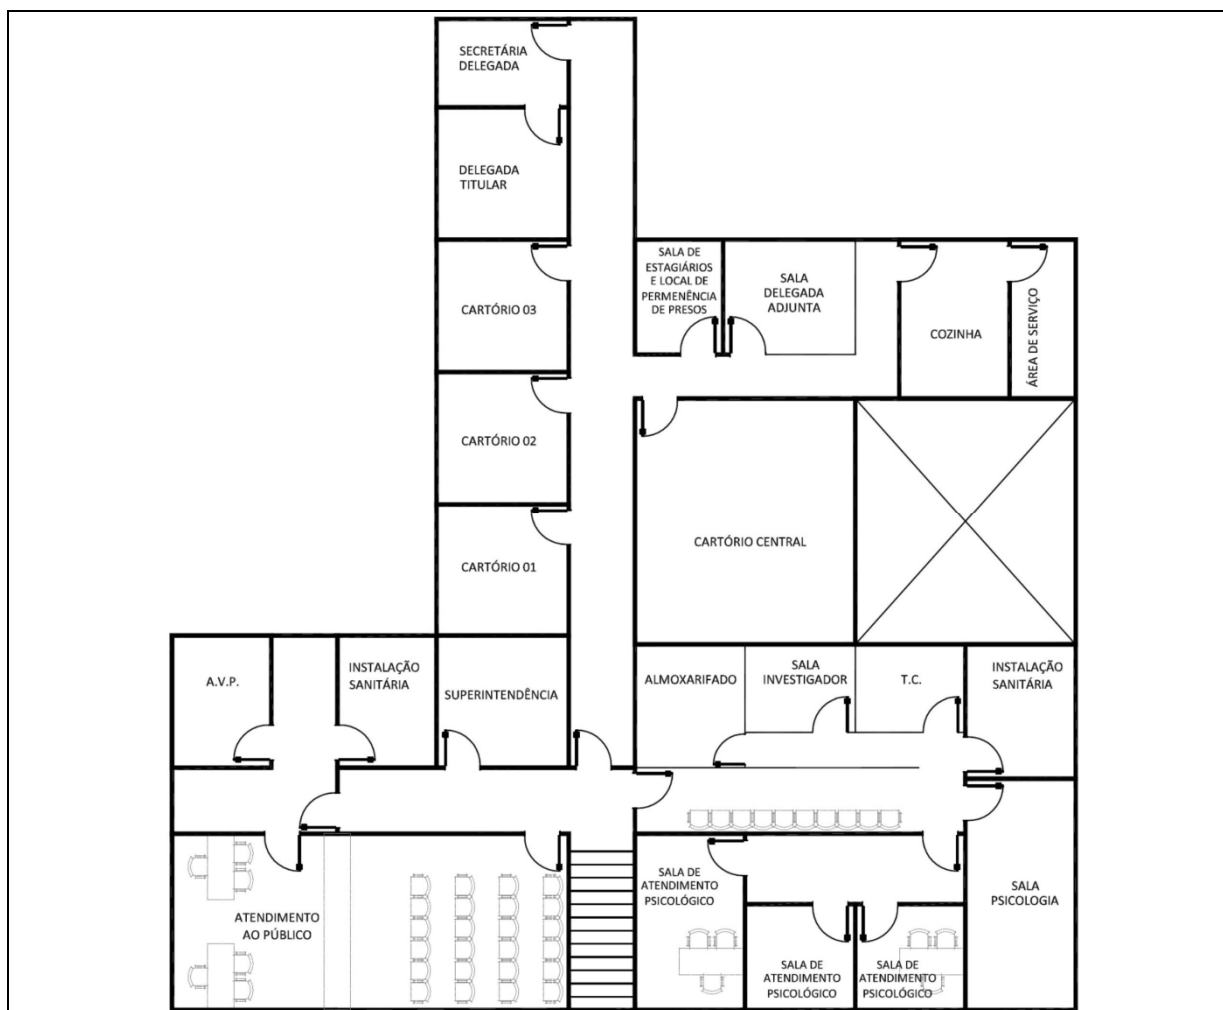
PLANTA BAIXA DO NUCRIA⁸¹
